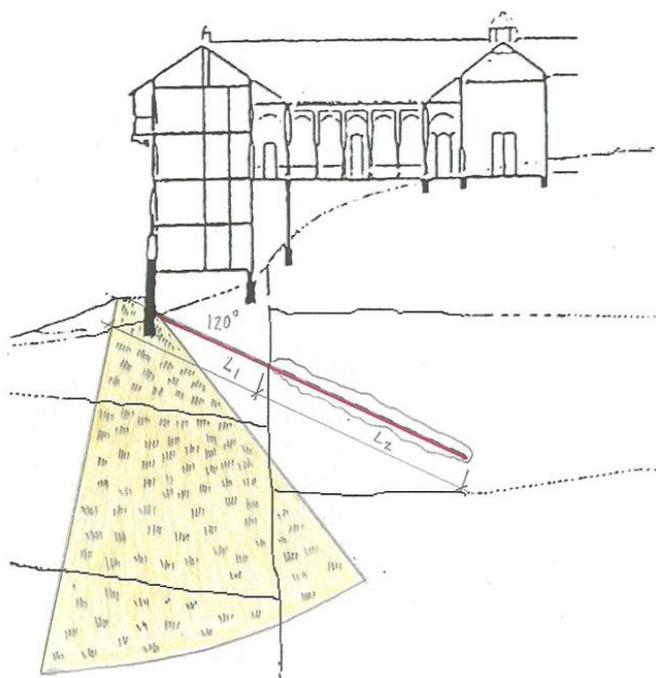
Situación de los anclajes. Dibujos cedidos por el CEDEX.
